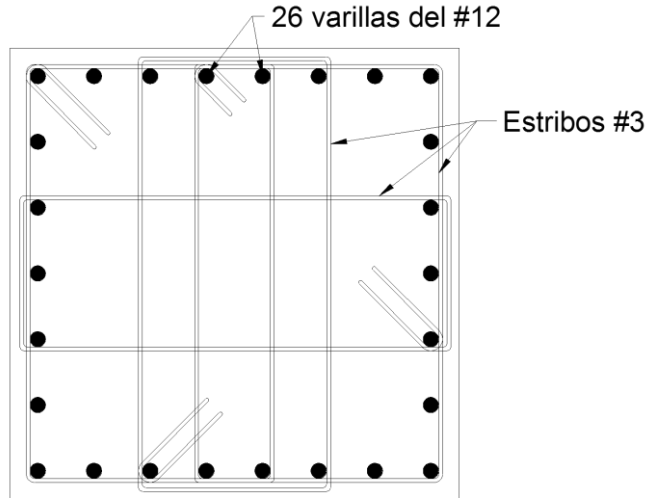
Detallado de refuerzo longitudinal y estribos para las columnas C1.
